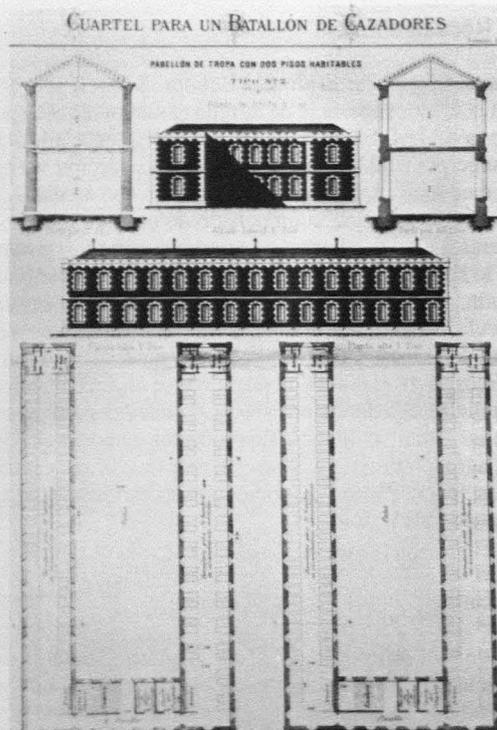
Cuartel para un batallón de Cazadores: disposición de planta en H, alzados y secciones de dependencias de tropa. (*Cuarteles Tipos*, 1892, 1892, Lám. 8).
